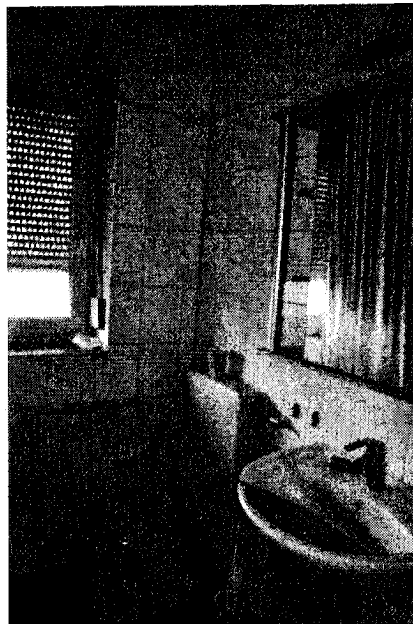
Erdgeschoss Duschbad mit WC und Handwaschbecken
